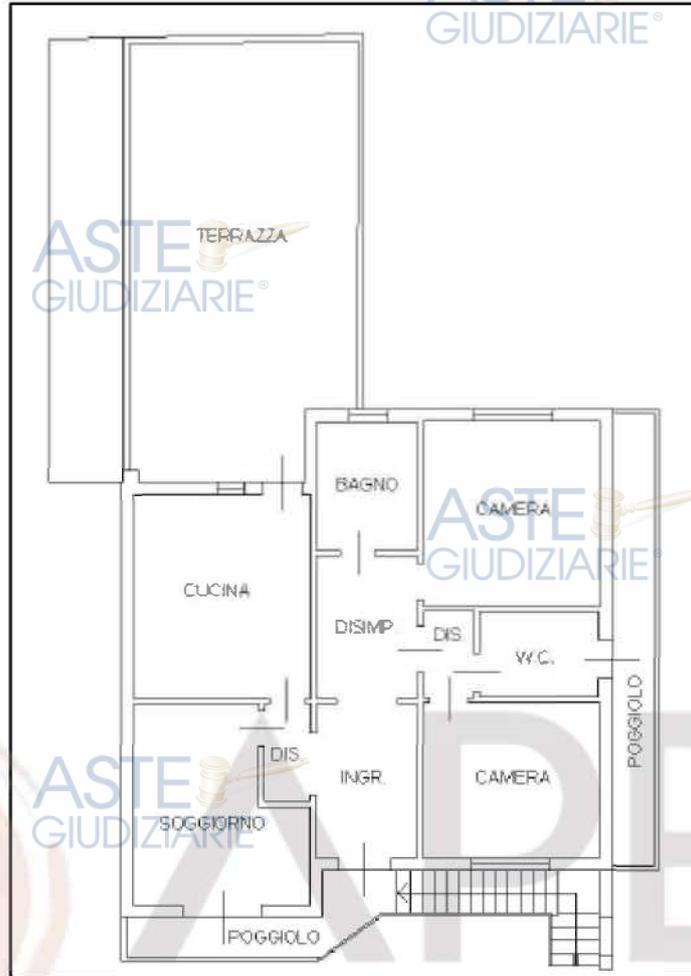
Pianta del primo piano (tratta dalla planimetria catastale)
